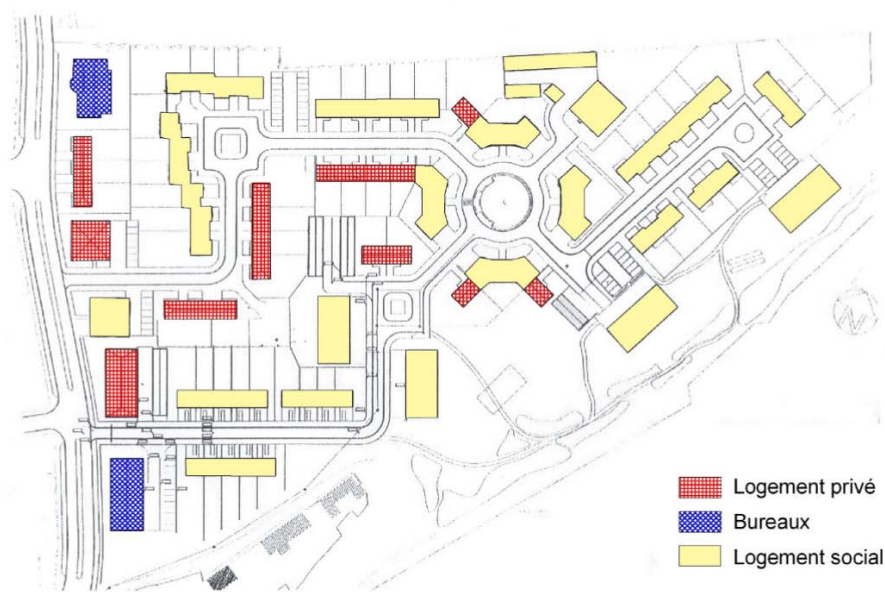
Quartier mixte construit sur l'ancien site des ateliers Germain à Monceau sur Sambre
